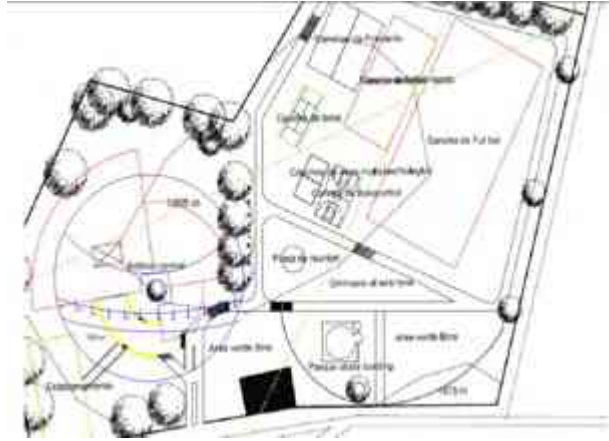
, Disposición de asoleamiento en primera propuesta de distribución, Centro cultural y Deportivo.
